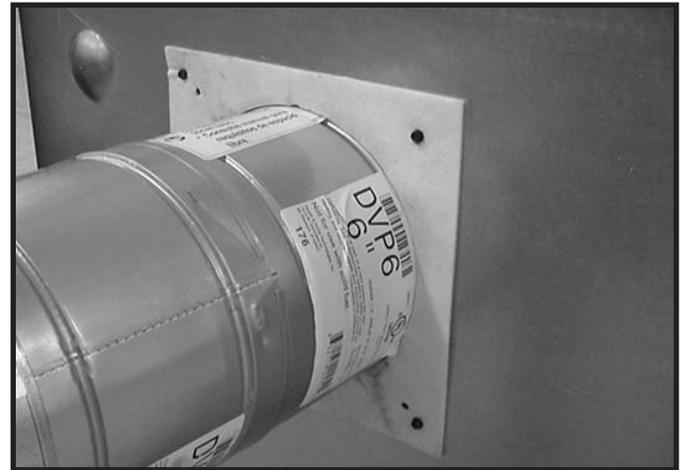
(foyer générique illustré) Posez la première section du conduit d'évacuation (elle se mettra en place avec un bruit sec). Glissez le joint d'isolation sur cette section du conduit, contre l'appareil, en passant sur les languettes. Utilisez les quatre vis autotaraudeuses pour fixer le joint à l'enveloppe extérieure.
